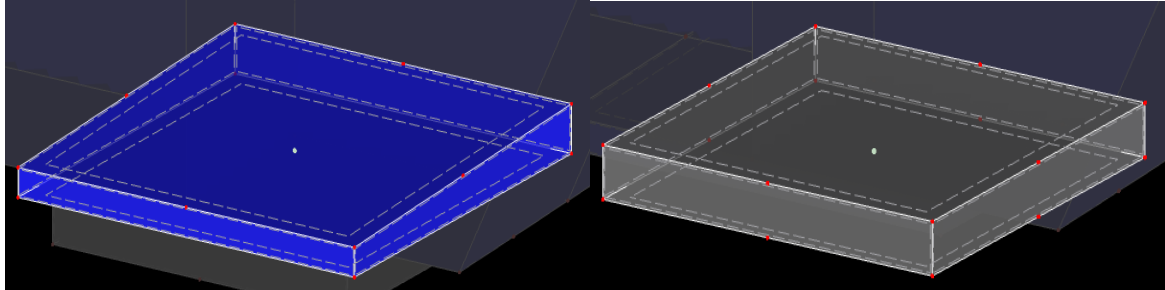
APOYO METÁLICO DE ACERO S-355
